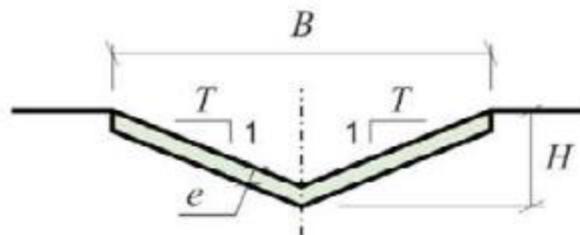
Tipico sezione fossato di drenaggio longitudinale
